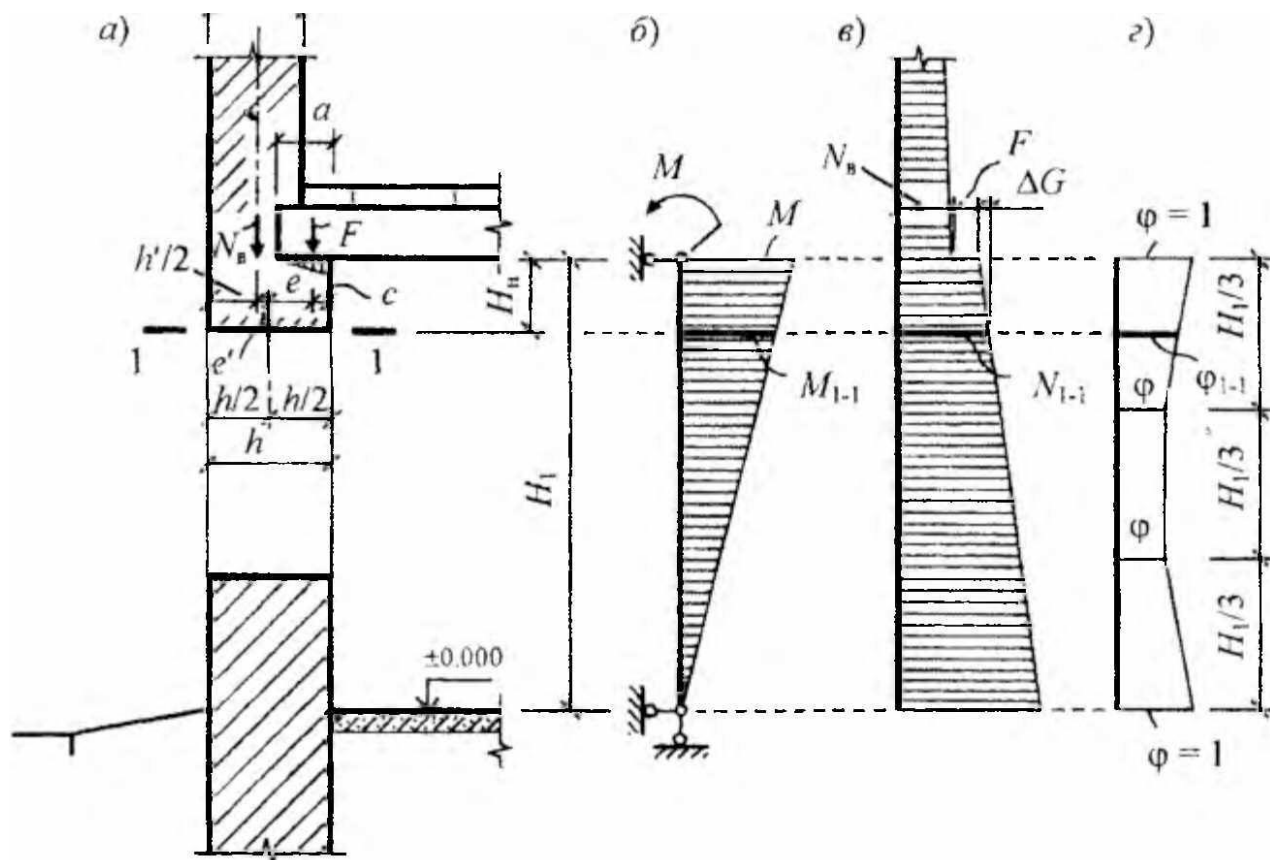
К расчету простенка 1-го этажа: а)- конструктивная схема, б) – расчетная схема и эпюра изгибающих моментов: в) – эпюра продольных сил, г) - эпюра коэффициента продольного изгиба.
